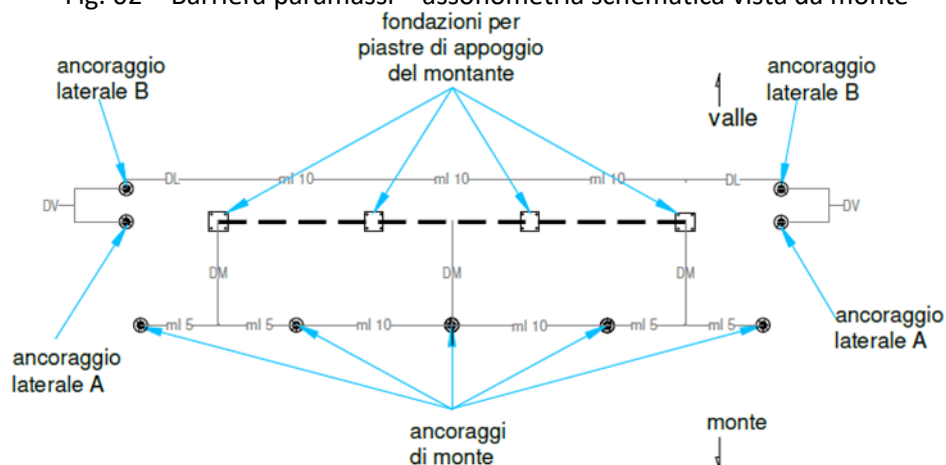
Barriera paramassi – schema delle fondazioni – pianta
